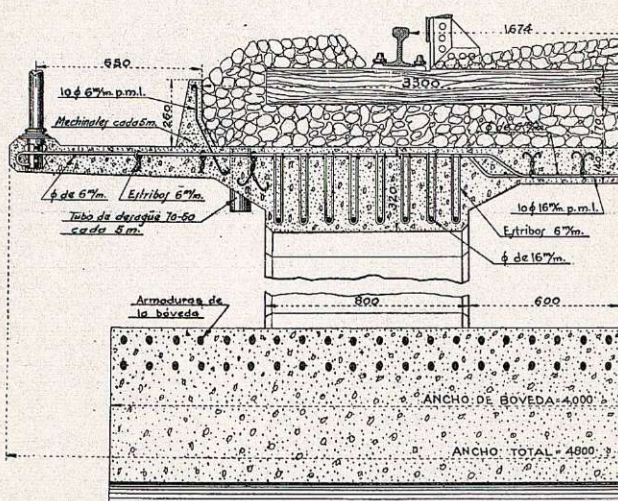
Arcos de hormigón en masa rebajados al $1/4$.
